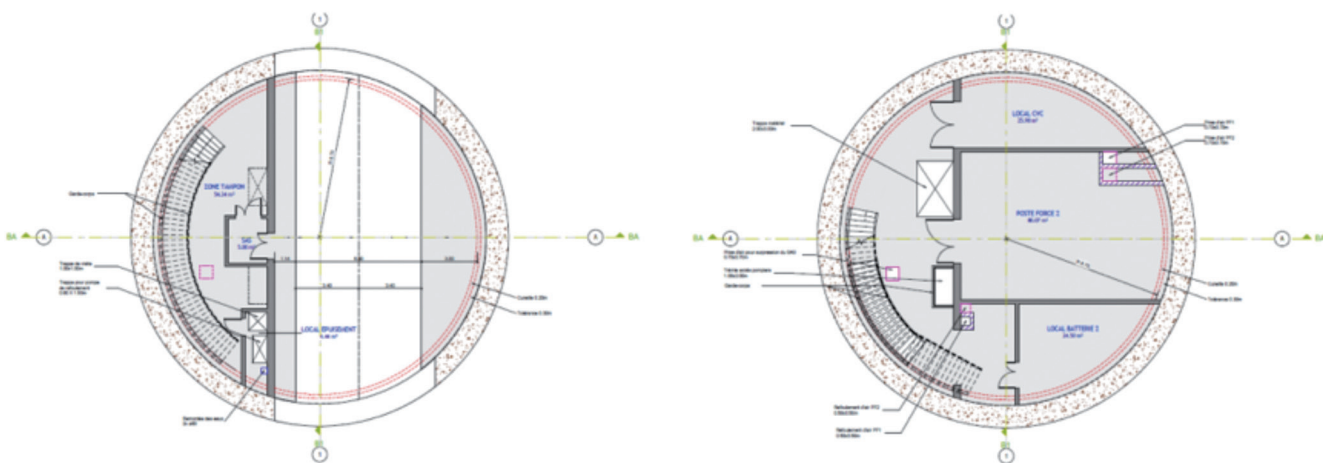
Vues en plan de plusieurs niveaux d'un puits type 4
